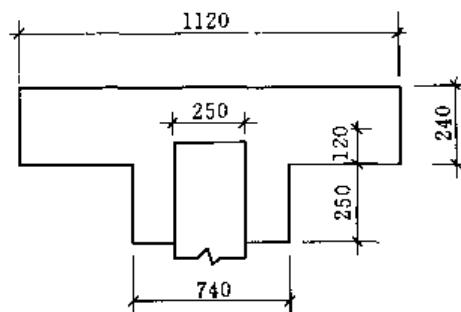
大梁及窗间墙构造简图（单位：mm）
